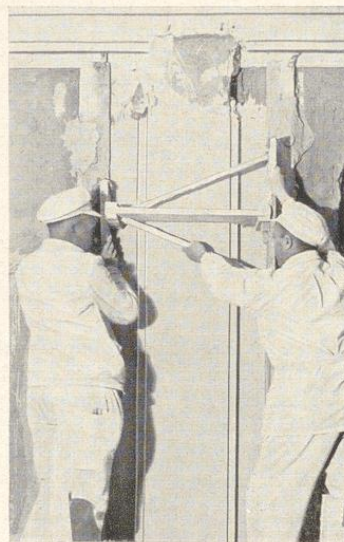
Wandzug eines Pilasters mit Mittelschablone
